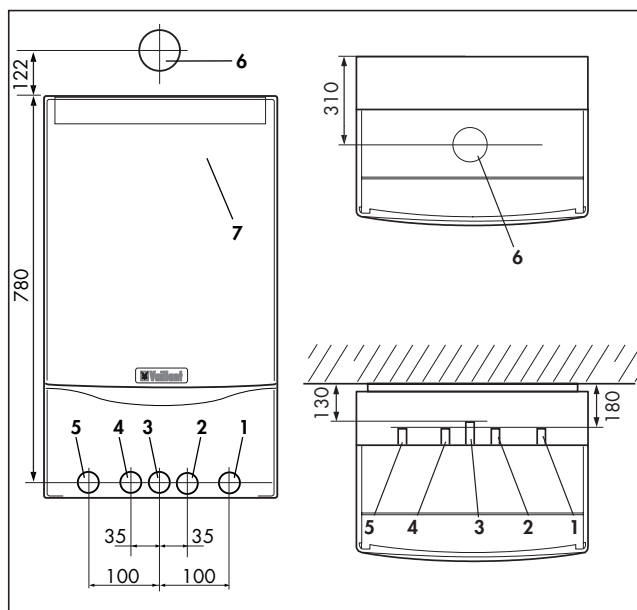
Dimensions de raccordement VUI 242-7, 282-7
